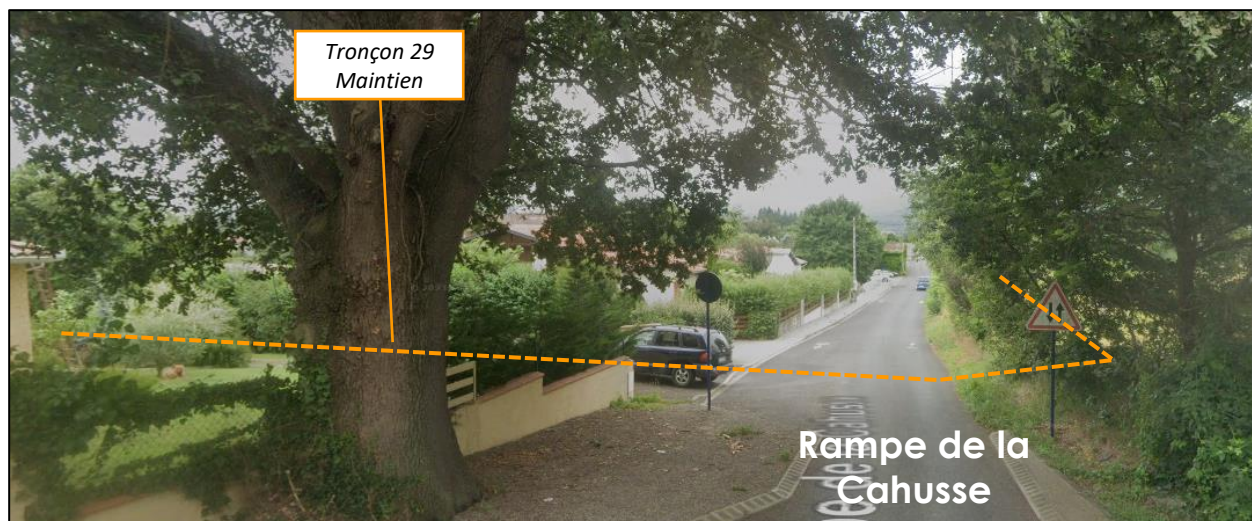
Photo – Traversée de la rampe de la Cahusse
